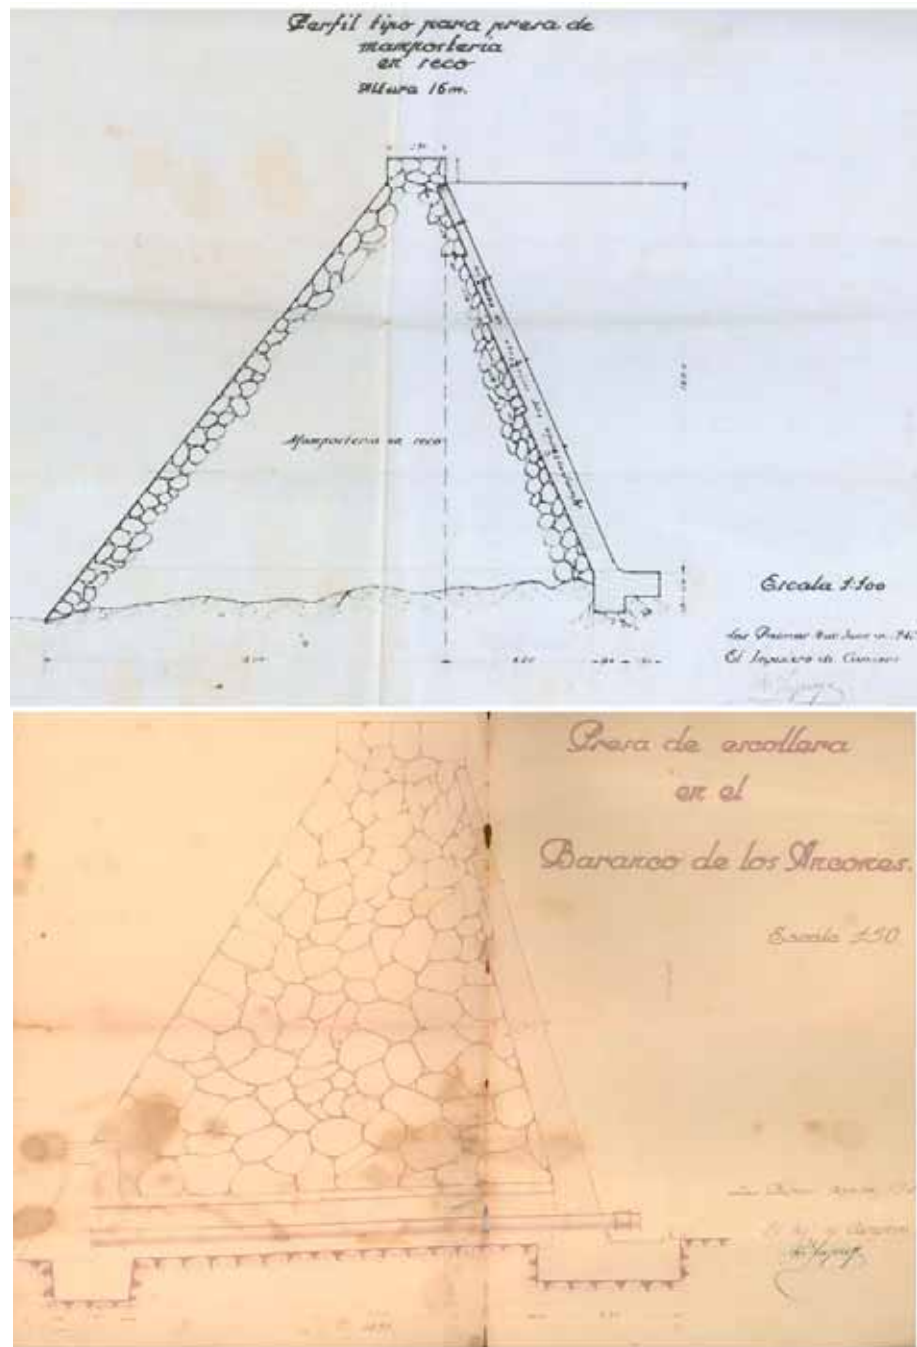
Secciones tipo Presa de escollera y de Mampostería en seco firmadas por el Ingeniero de Caminos D. Rafael Ynzenga en 1942
